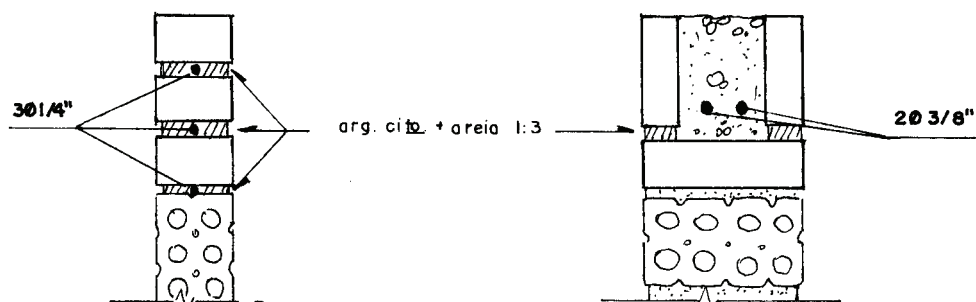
Cinta de amarração em alvenaria de tijolo furado
